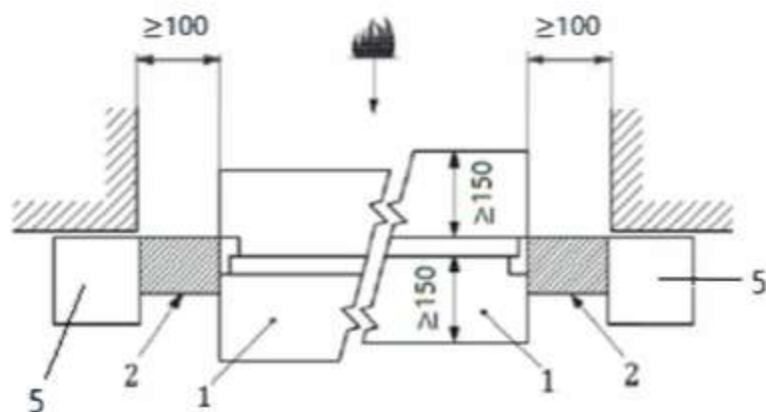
Exemplo de ensaio de porta em uma construção de suporte padronizada rígida
